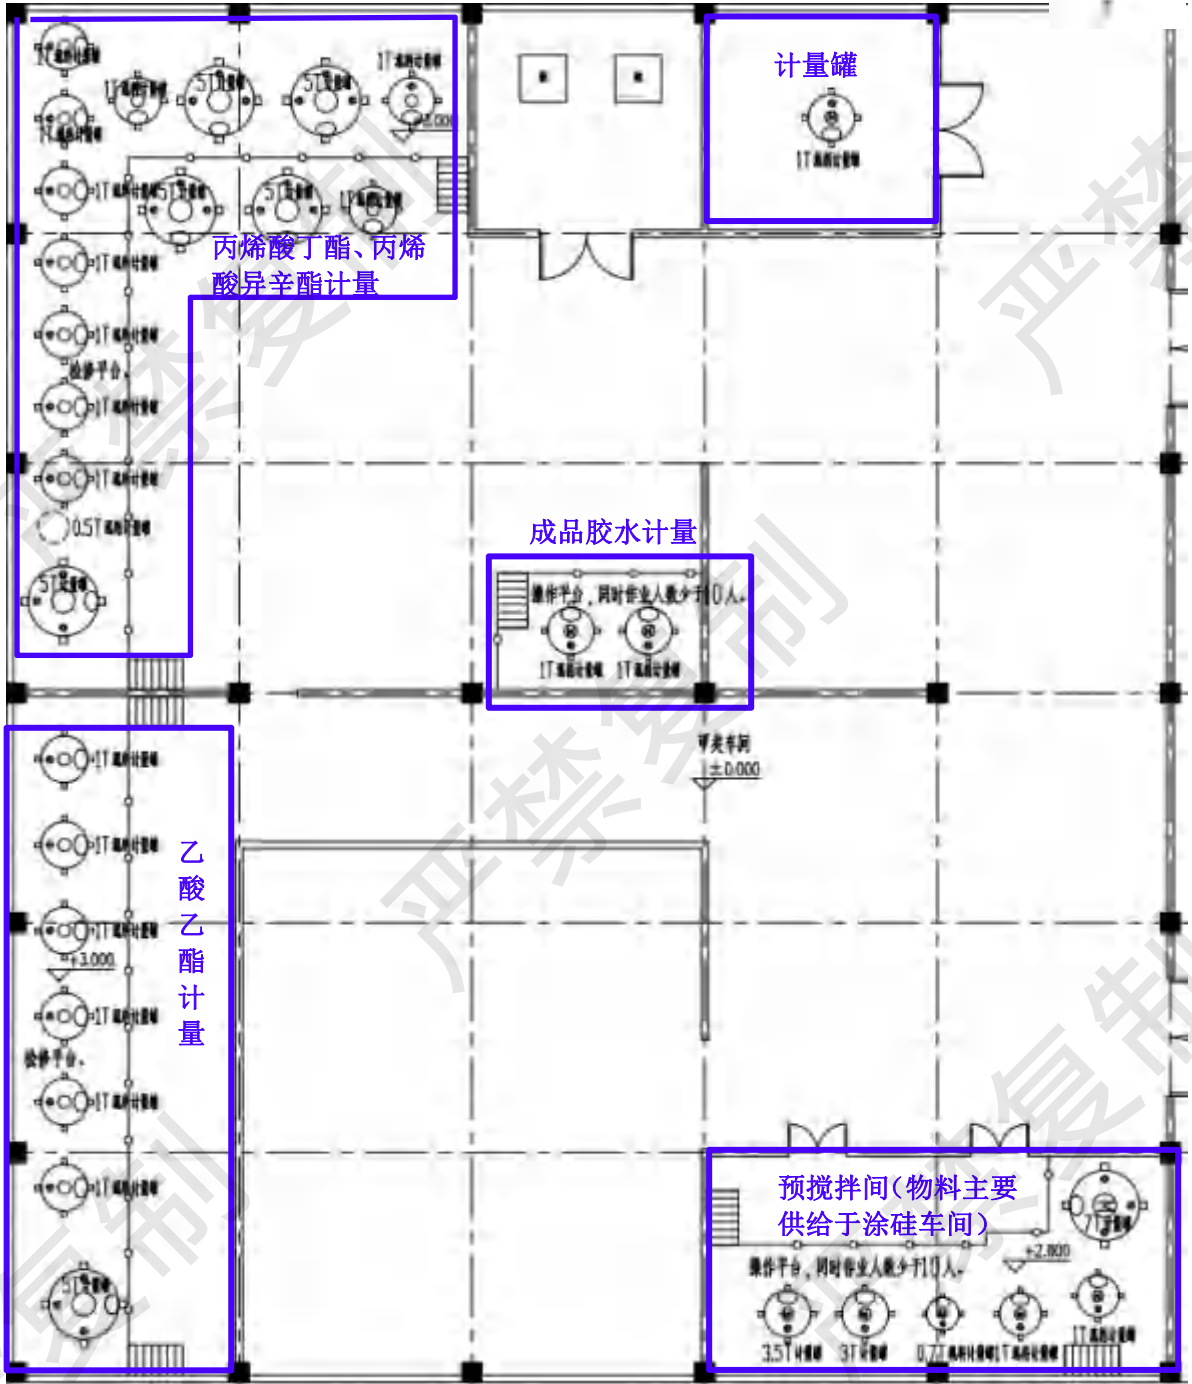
技改扩建后车间（厂房 C-计量车间）平面布置图
